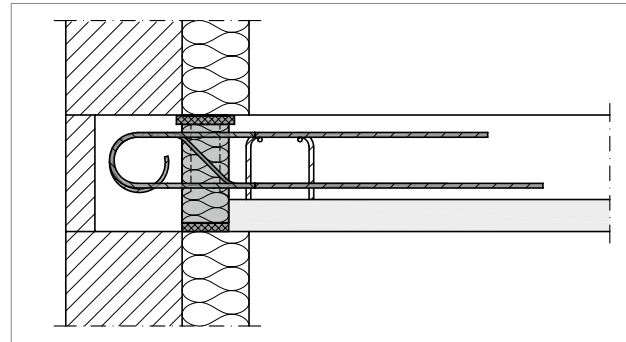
Schöck Rutherma® T type DF : liaison pour façade en maçonnerie et plancher constitué de prédalles
